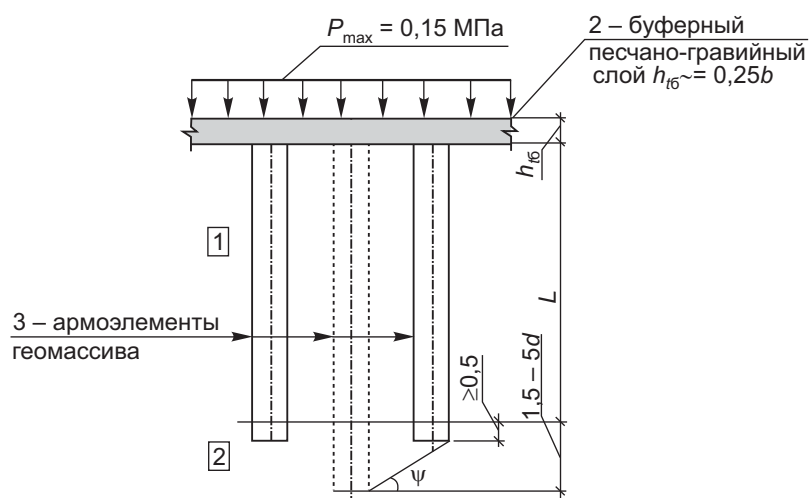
Расчетная схема геомассива к примеру расчета упрочняемого основания методом вертикального армирования
